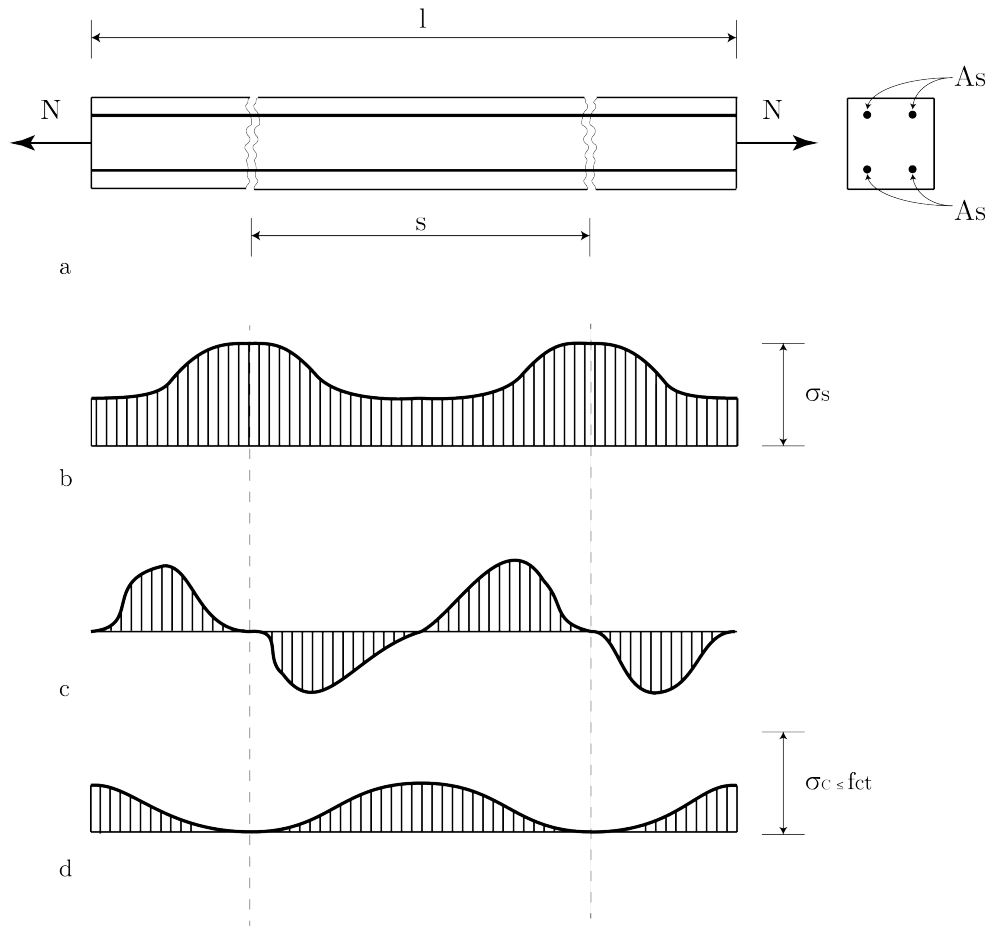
Comportamento do CA à tração. a- Fissuras em um elemento solicitado à tração, b- tensão na barra de aço, c- aderência e d- tensão no concreto. Fonte: Adaptado de Ghali, Favre e Elbadry (2002)
